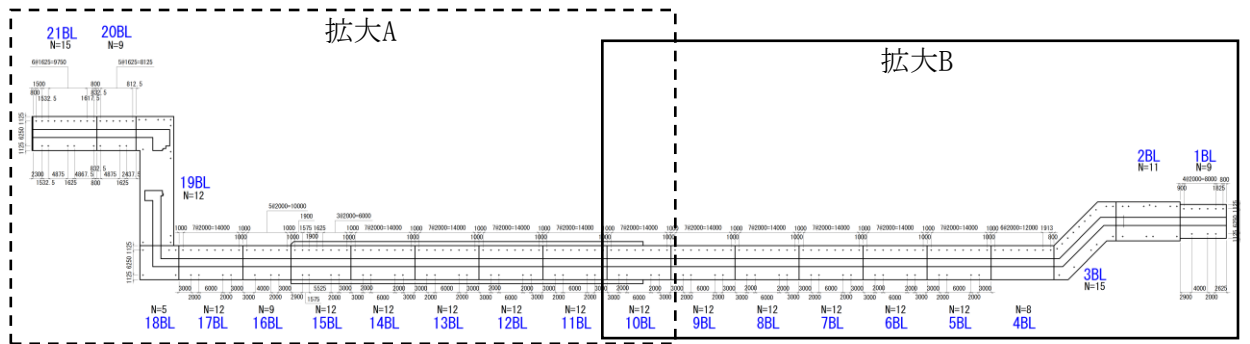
(1) 防波壁（逆T擁壁）のグラウンドアンカ配置図（全体平面図）
